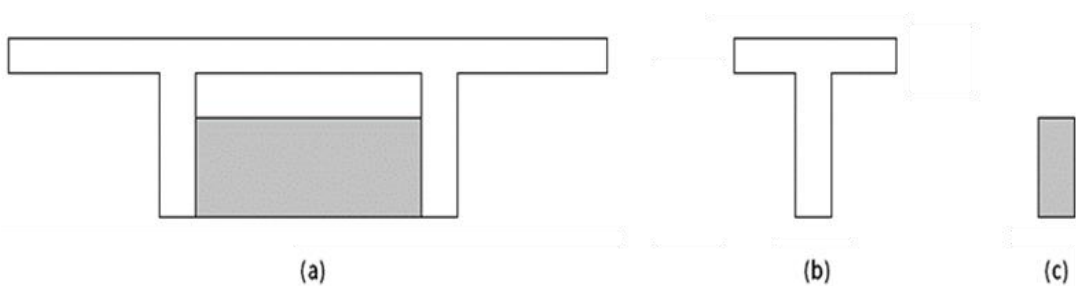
Exemplo de uma seção transversal em duplo T (a), seções transversais (a) viga longitudinal e (b) viga transversal
